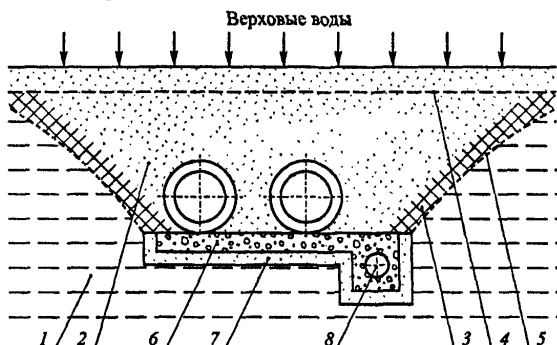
Схема действия попутного понижающего дренажа при бесканальной прокладке теплопроводов:
